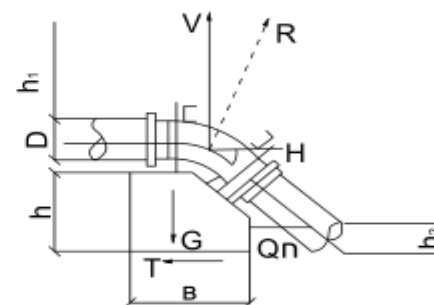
Монтажные чертежи упоров на горизонтальных и вертикальных поворотах трубопровода
